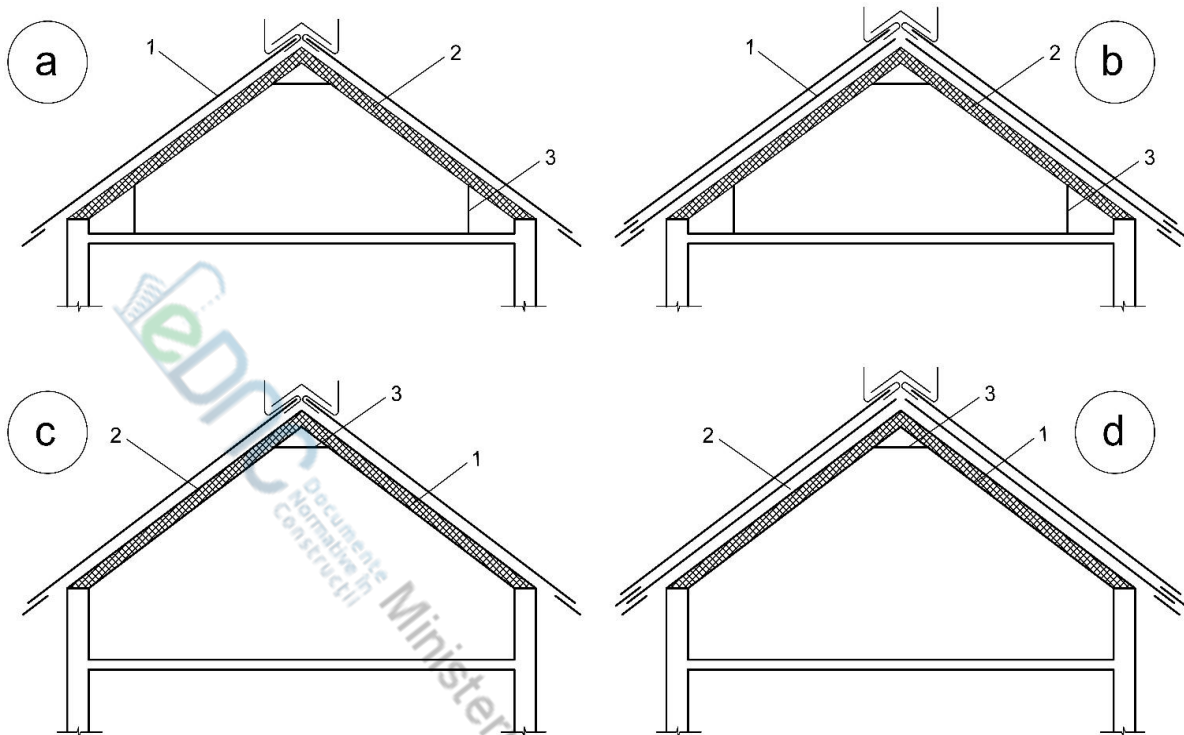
Теплоизоляция и вентиляция мансардных крыш (с двумя теплоизолированными плоскостями)
